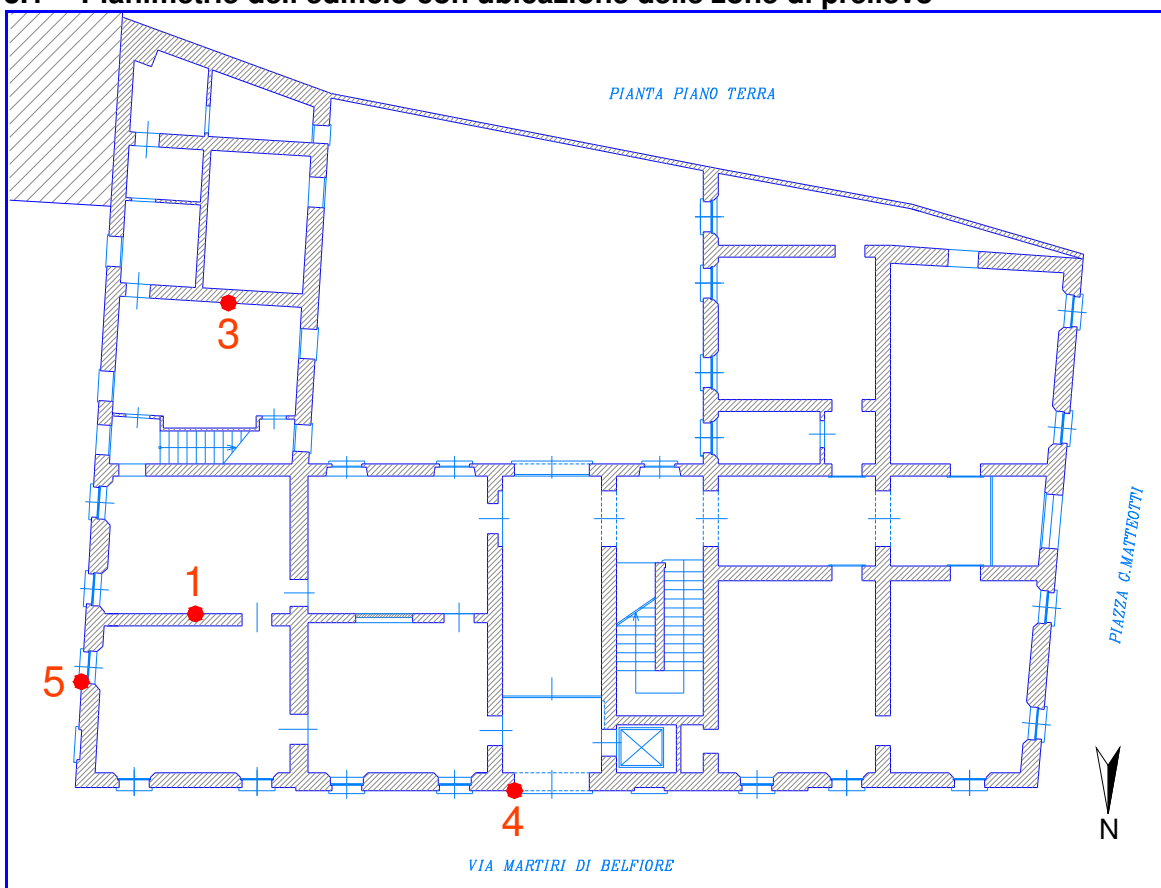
Planimetria del piano terra con ubicazione delle zone di prelievo
